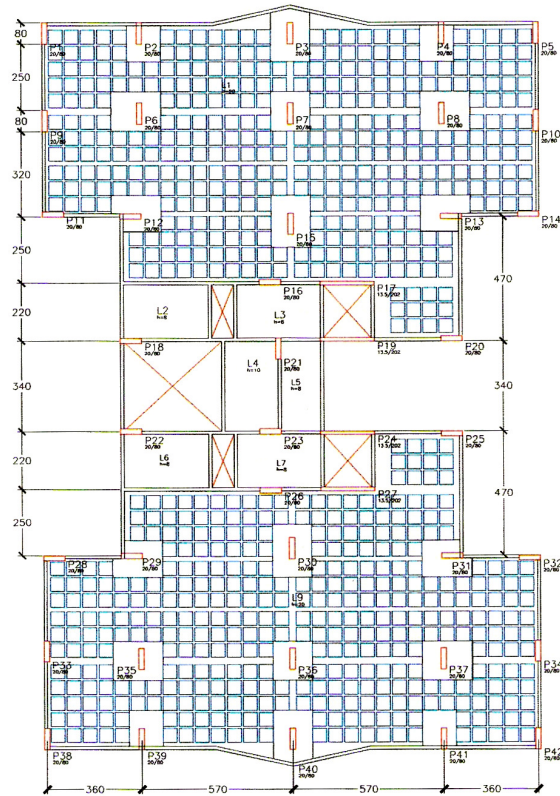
Planta baixa do segundo exemplo (MARTINS, 2003)
